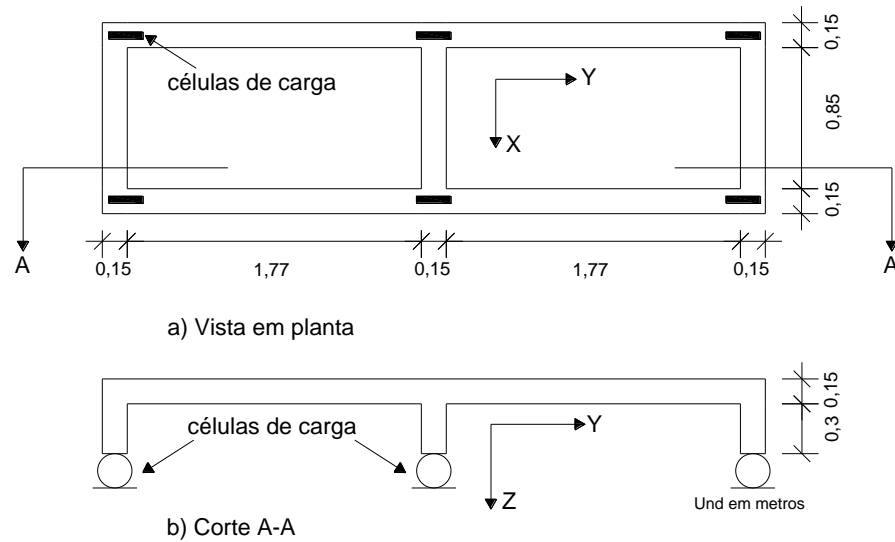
Planta e corte da plataforma de ensaios (Alves, 1997).
